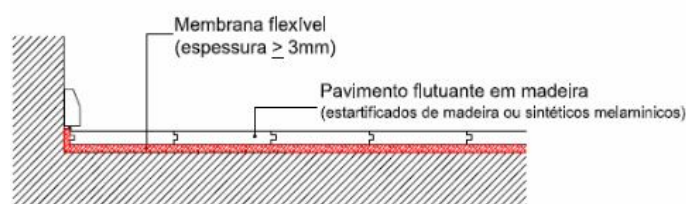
Pavimentos flutuantes em madeira [10]
